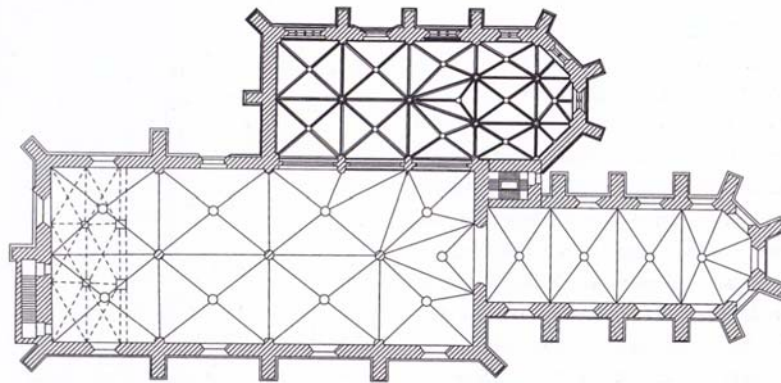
Enns, ehem. Minoritenkirche mit Wallseerkapelle, Grundriss. Repro aus: Geschichte der bildenden Kunst in Österreich. Gotik (wie Anm. 218)
